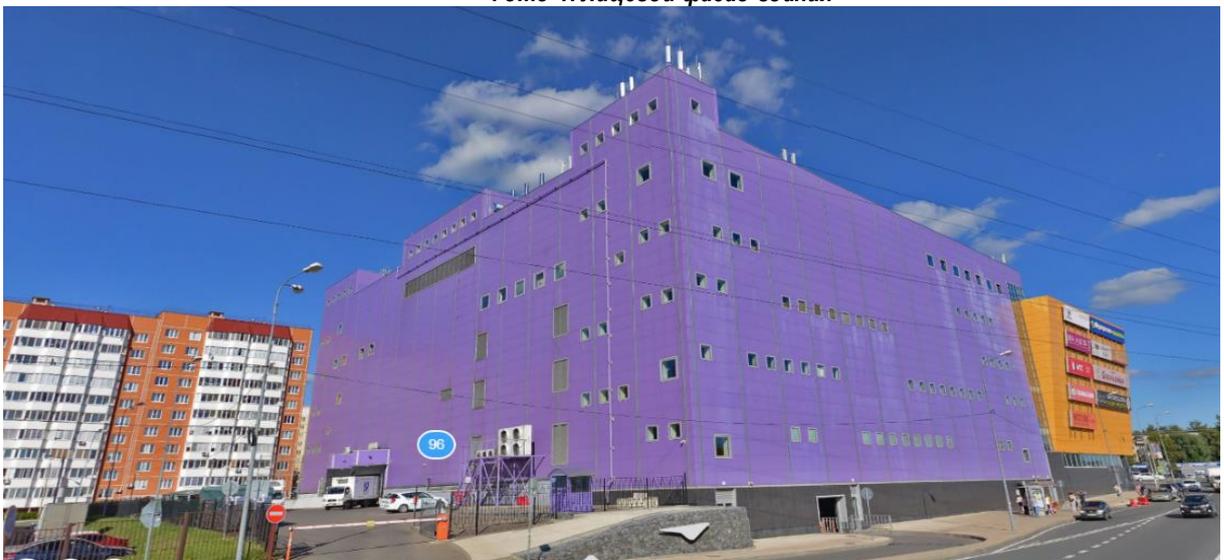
Тильный и торцевой фасад здания (источник: интернет-ресурсы)
